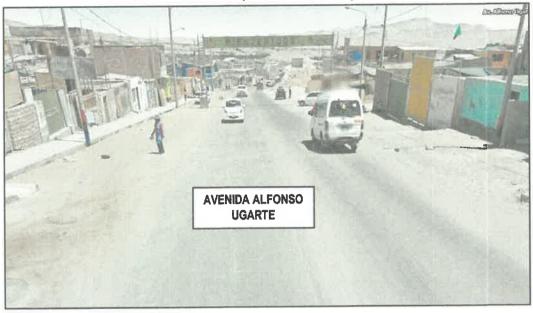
Vía Arterial (Avenida Alfonso Ugarte)
